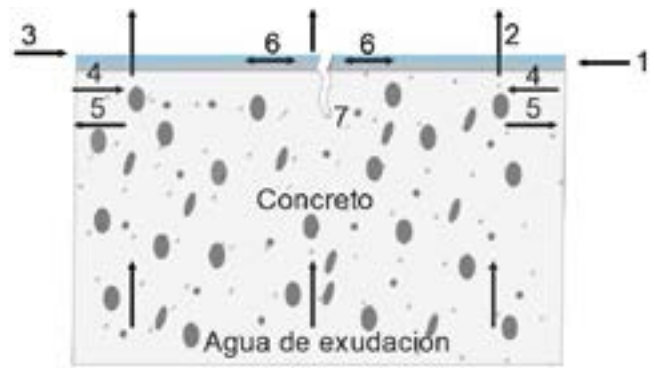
Formación de fisuras por retracción plástica (Aire, 2011)
